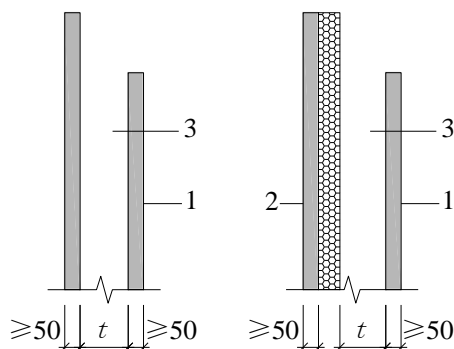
预制空心墙构件及预制夹心保温空心墙构件厚度构造
